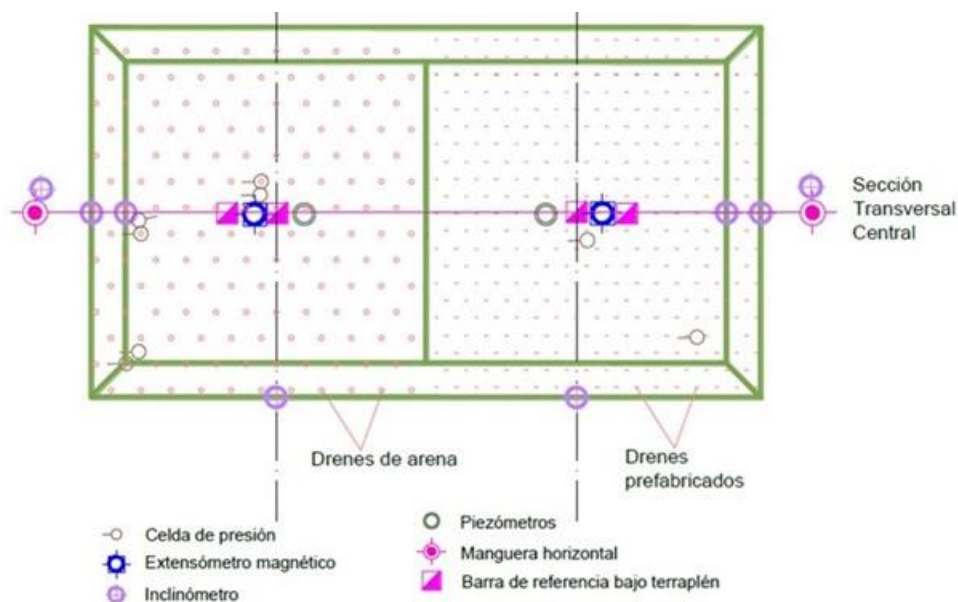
Esquema en planta de la instrumentación del TPDV
